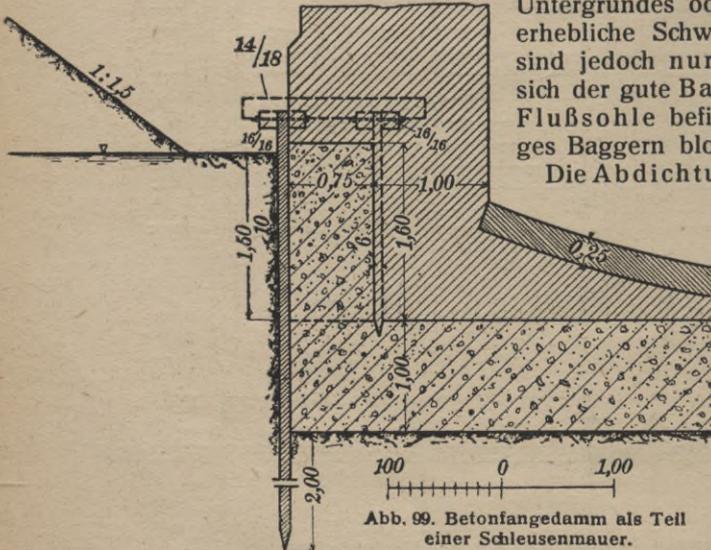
Betonfangedamm als Teil einer Schleusenmauer.
